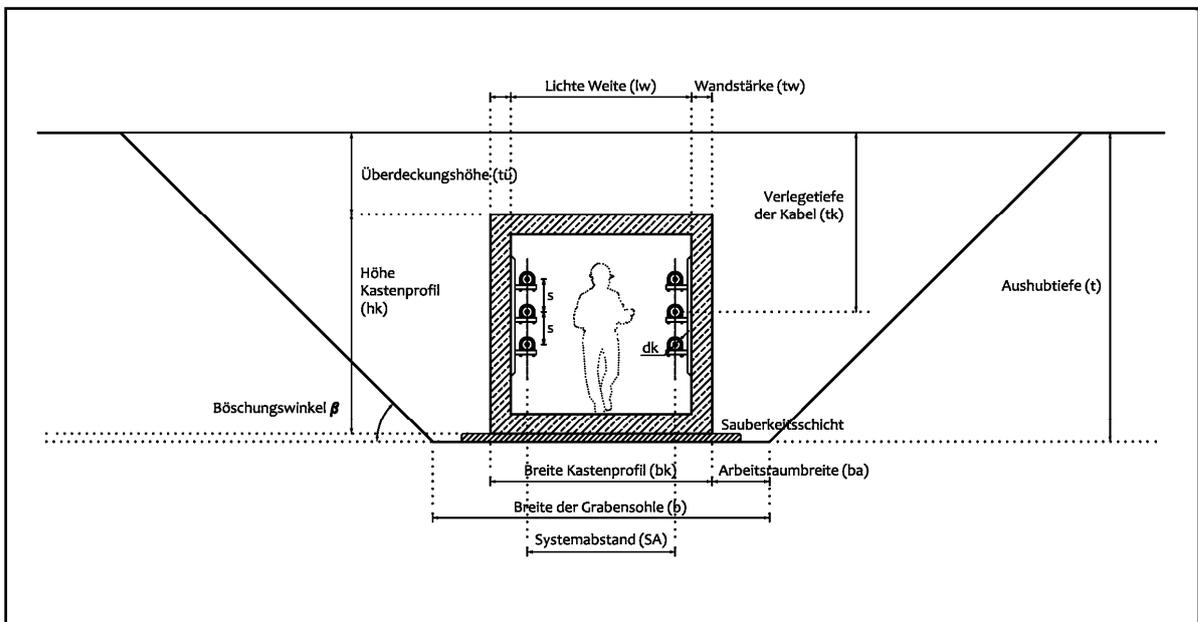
Geometrie der Variante 3, Verlegung im oberflächennahen Tunnel – Fertigteilbauweise
